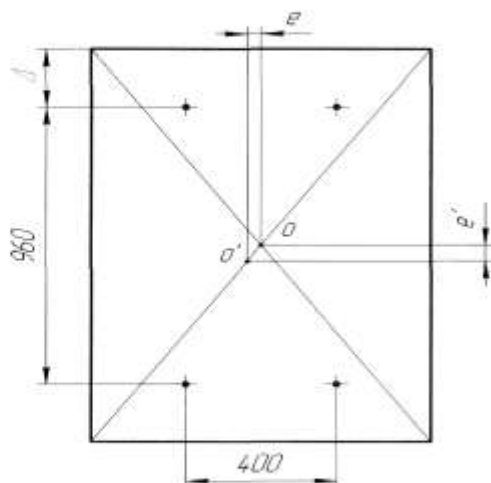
Схема фундаментной площадки под подъемник АВ-24
